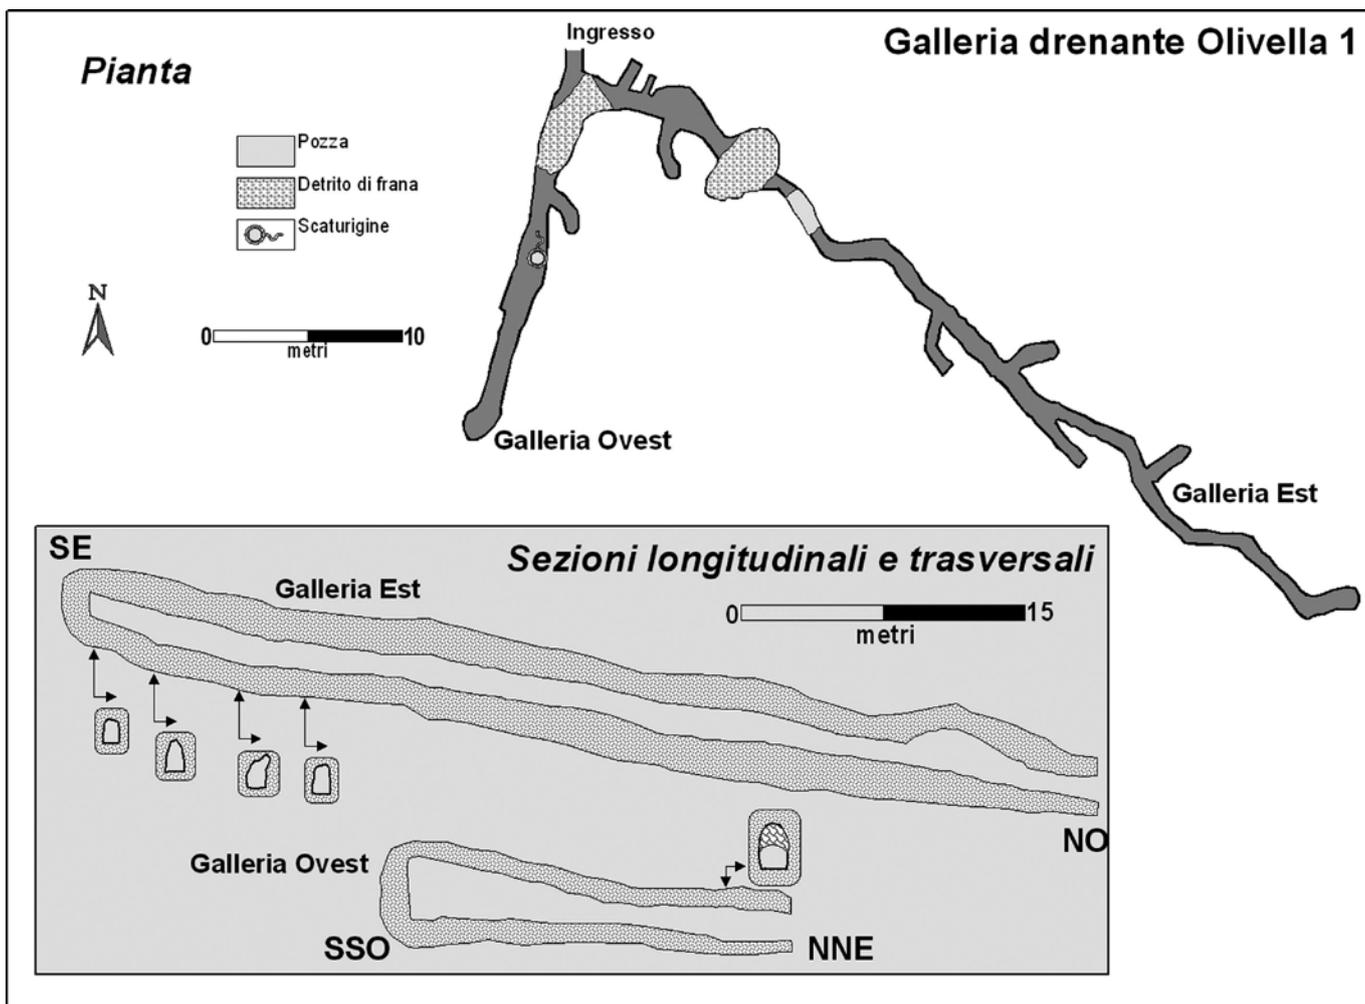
Pianta e sezioni longitudinale e trasversali della galleria Olivella 1.
